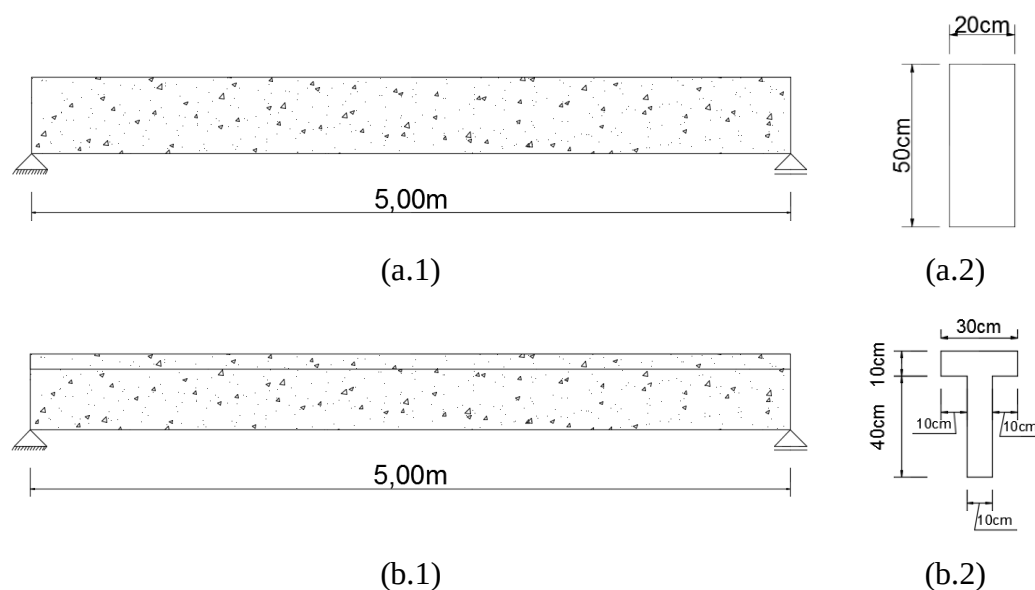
Vigas analisadas: (a) viga retangular; (b) viga T.
